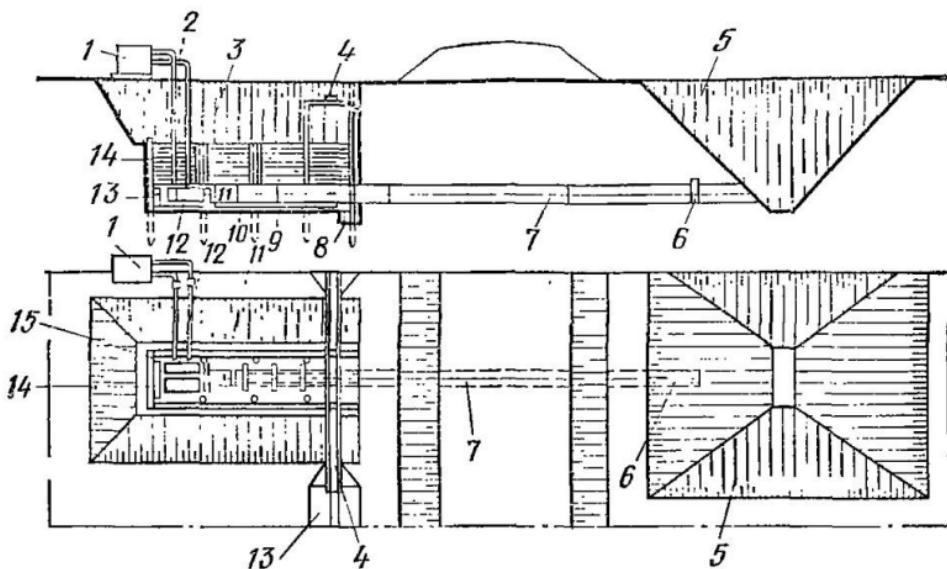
Схема домкратной установки для прокладки кожухов прокалыванием и продавливанием с ручной разработкой грунта
